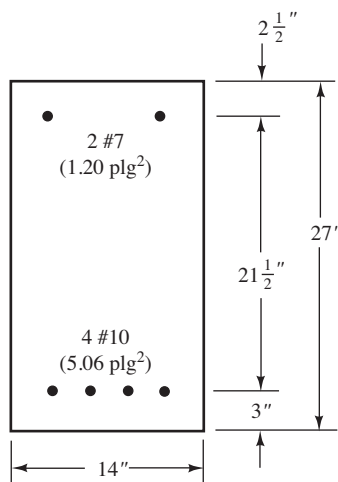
Sección transversal de la viga del ejemplo 5.8.
